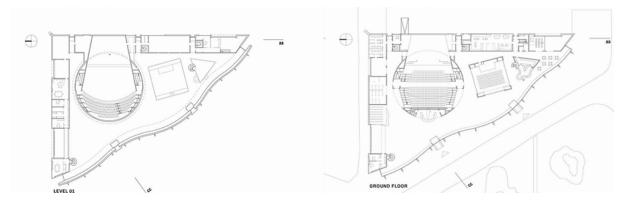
Figura II – Plantas primeiro e segundo pavimento – Centro Cultural Katuaq
